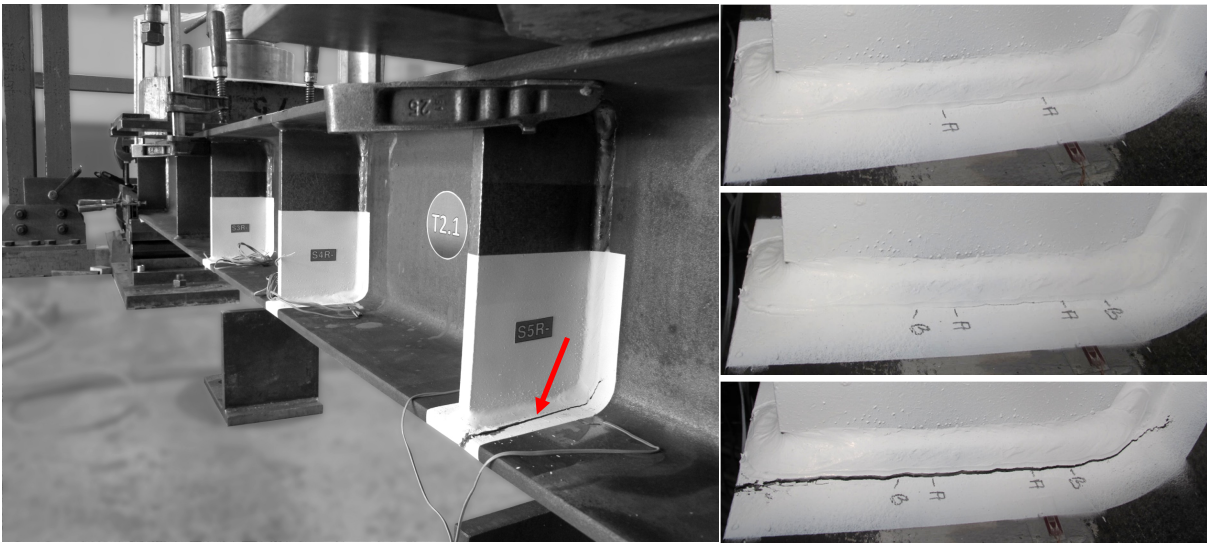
Isometrie und Draufsicht auf Risswachstum am Schweißnahtübergang der Quersteife
